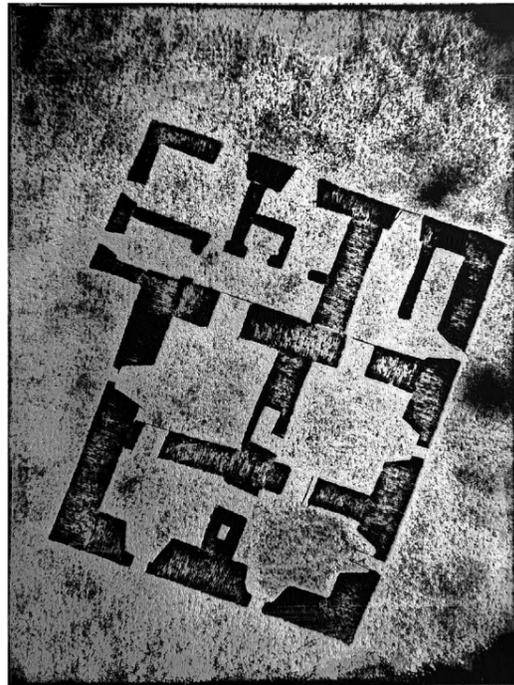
(gauche) Gravure du plan de rez-de-chaussée de la tour.
